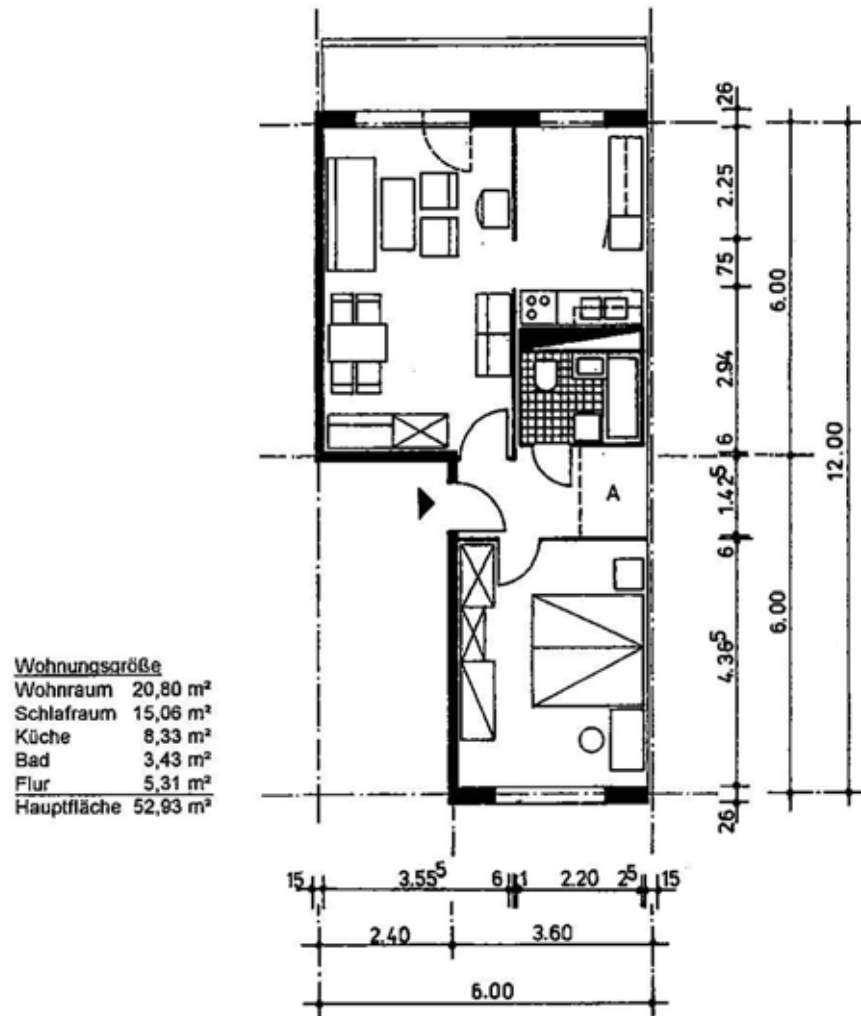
Grundriß einer 2-Raumwohnung
